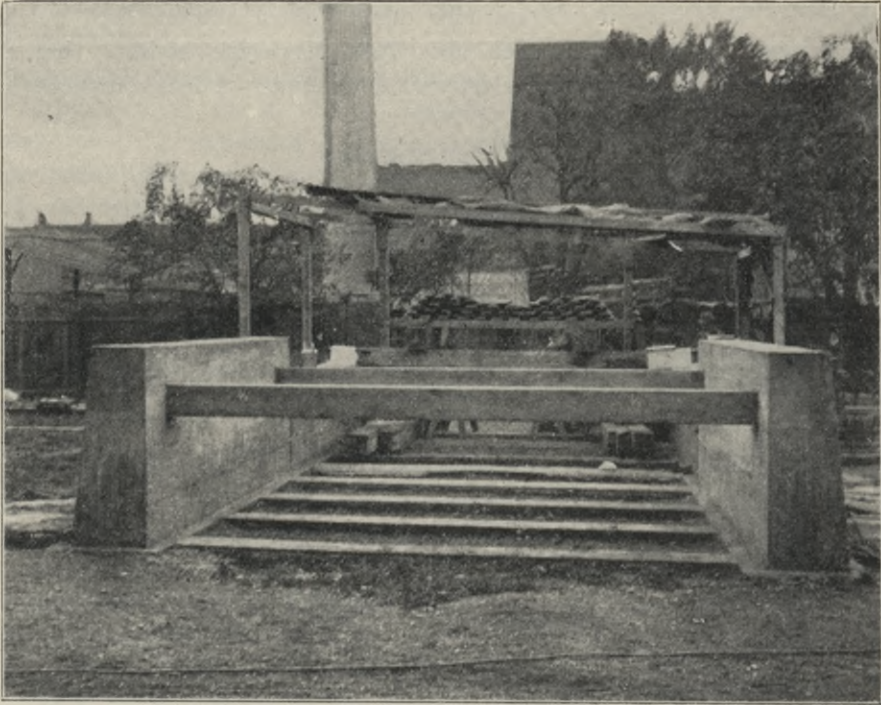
a. Beton-Widerlager mit eingemauerten Balken.
